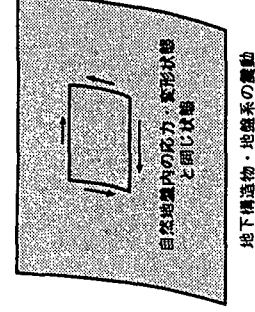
地下構造物に作用する地震力の概念的な説明
